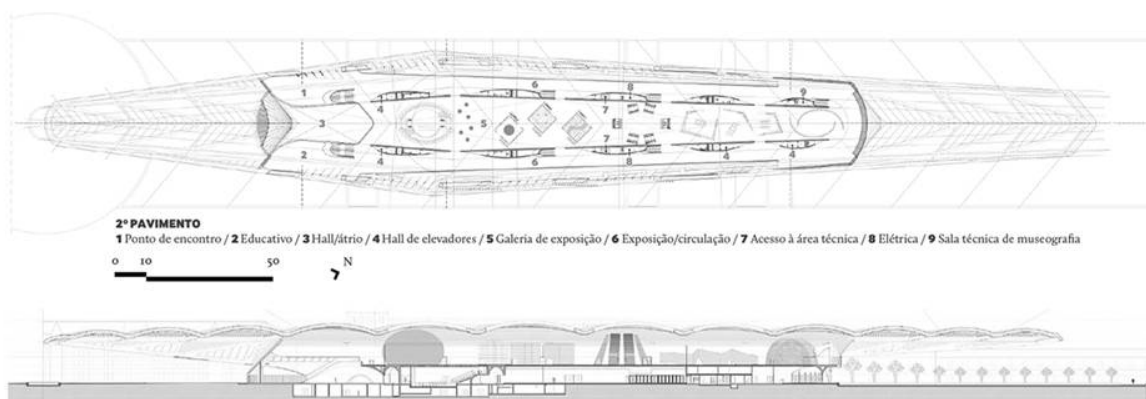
Museu do Amanhã: Planta do pavimento expositivo e corte longitudinal.
